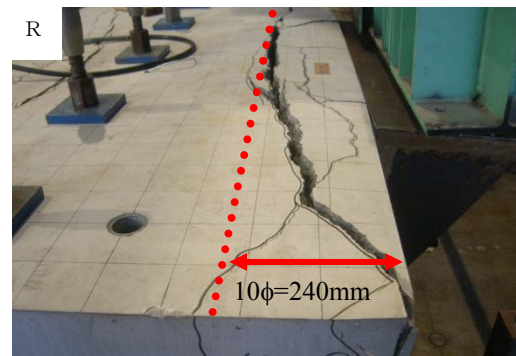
荷重試験終了時のひび割れ状況 (図-6 R 点)
